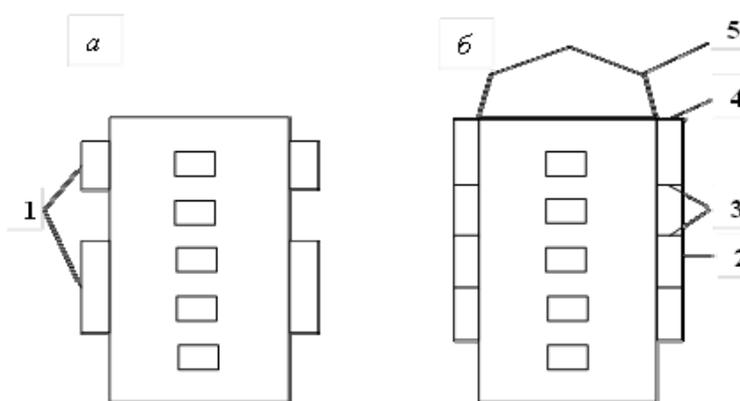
Схемы объединения квартир при помощи примыкающих (а) и подвесных (б) наружных блоков: 1 — блоки по типу «ласточкиного гнезда»; 2 — металлические тяжи; 3 — ригели, закрепляемые в уровне перекрытий к металлическим тяжам и поперечным несущим стенам; 4 — двухконсольная балка; 5 — надстроенный мансардный этаж
